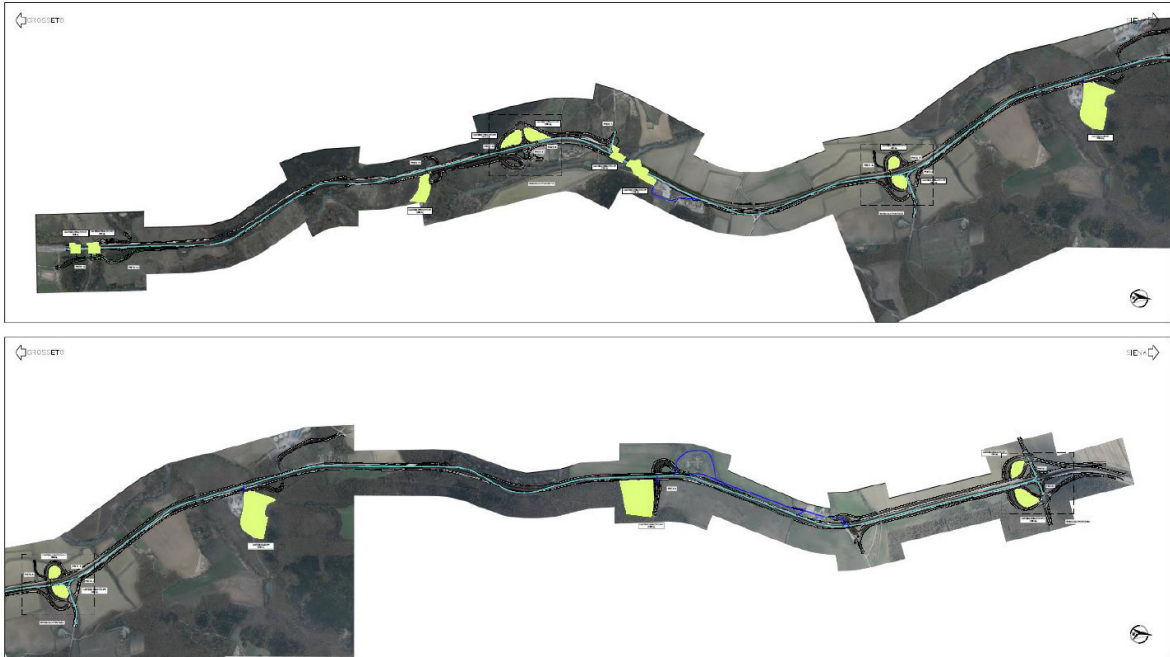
Planimetria con individuazione dei cantieri base e operativi
